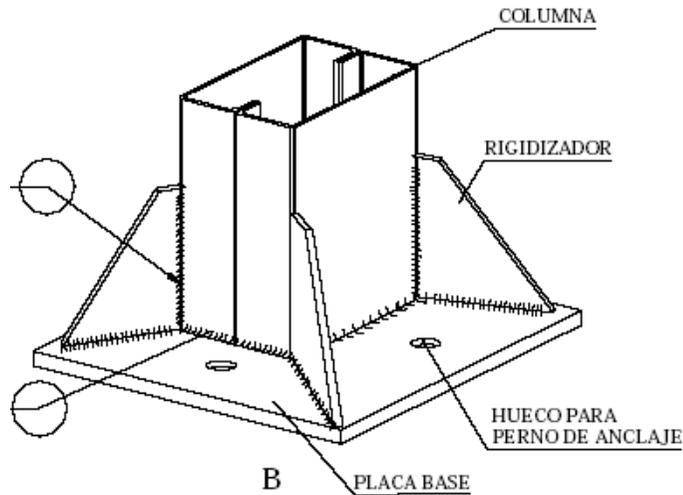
Esquema de la columna y la placa de anclaje con la cimentación.
